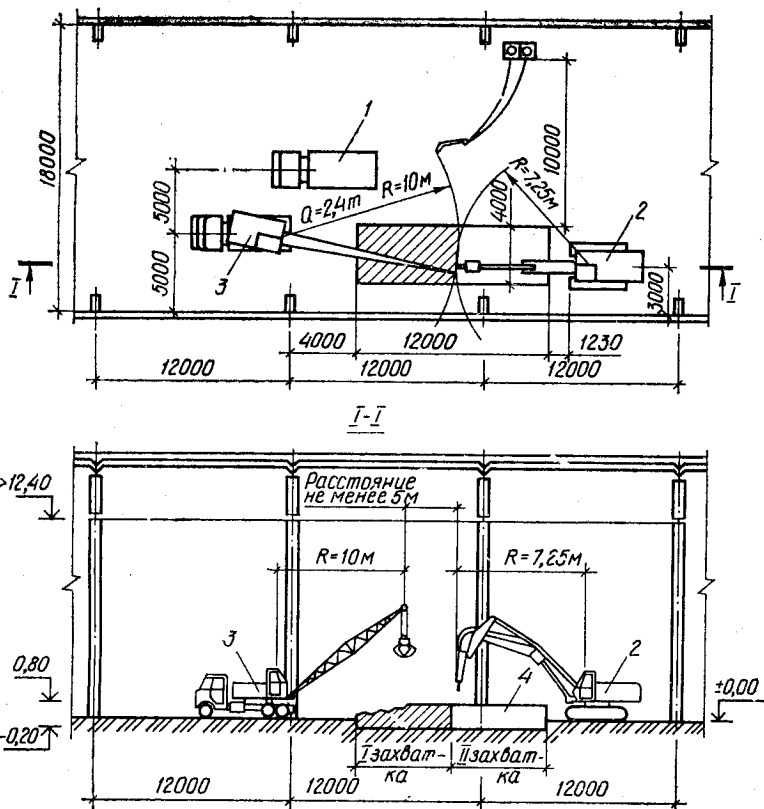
Схема разрушения железобетонных фундаментов гидромолотом СП-62 на базе экскаватора ЭО-4121:
